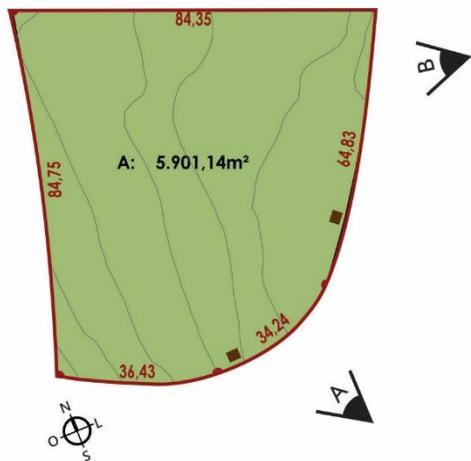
Imagens do terreno. Fonte: Autora (2018)
